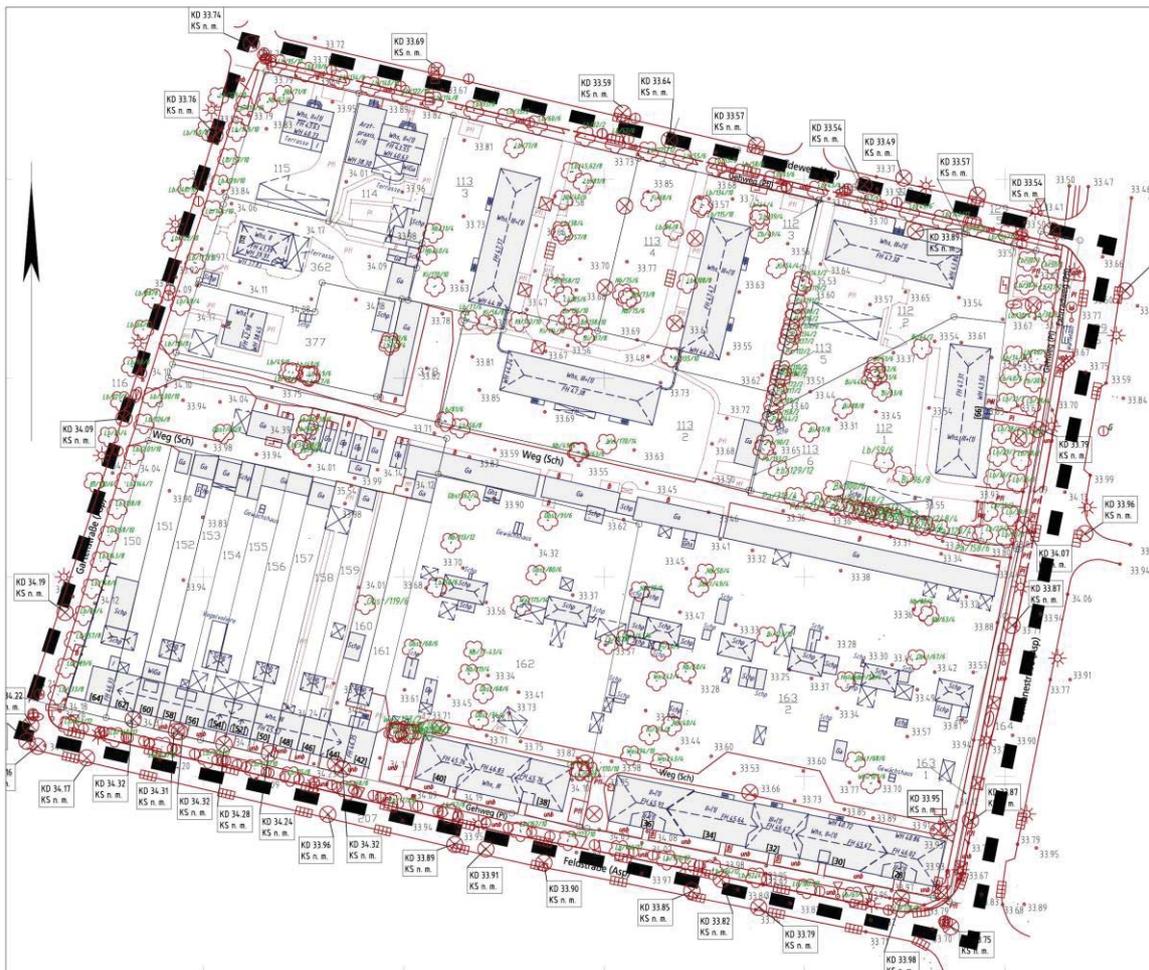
Ausschnitt Vermessungsplan mit Umgrenzung des Plangebietes
